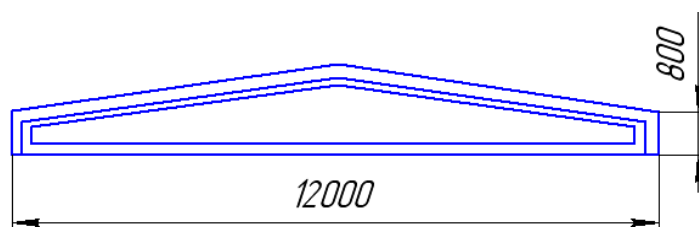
Железобетонная ферма серии 1.462-3
